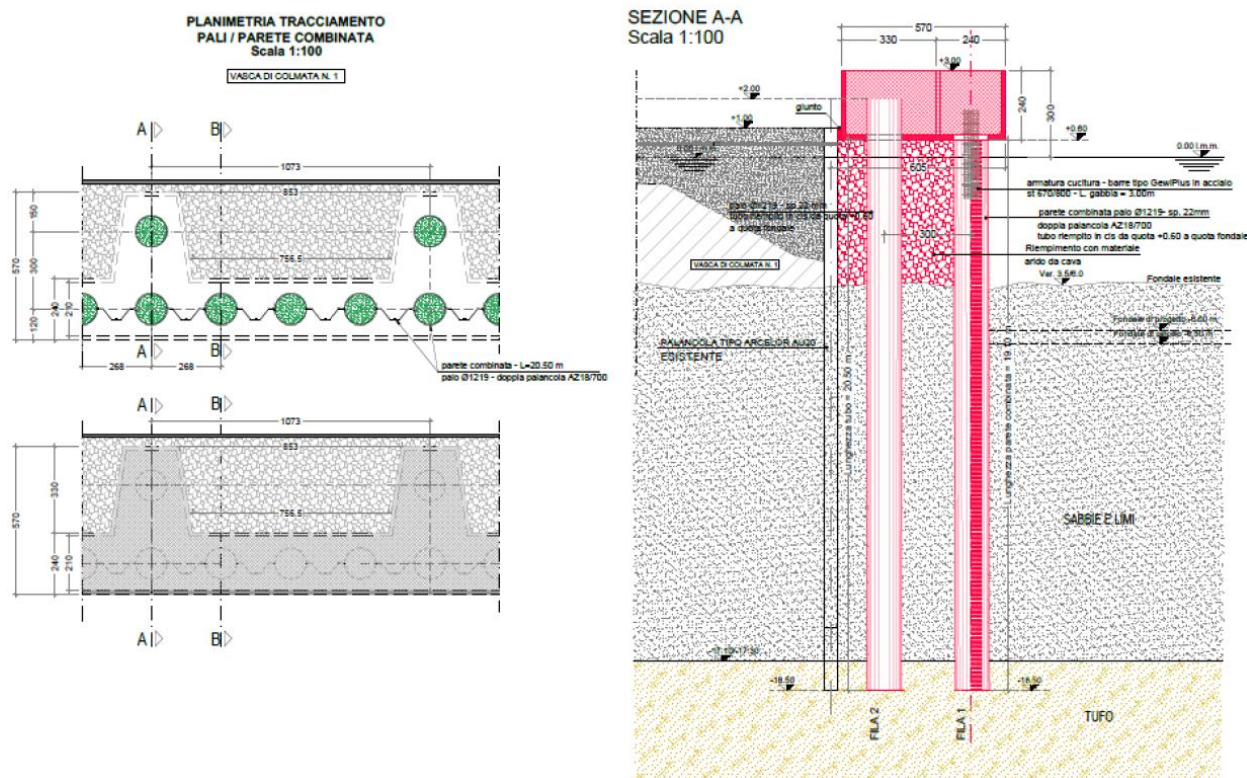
Sezione tipologica di progetto tratto C (stralcio elaborato MI061P-PDDS4022 - Progetto cassa di colmata – Sezioni)
